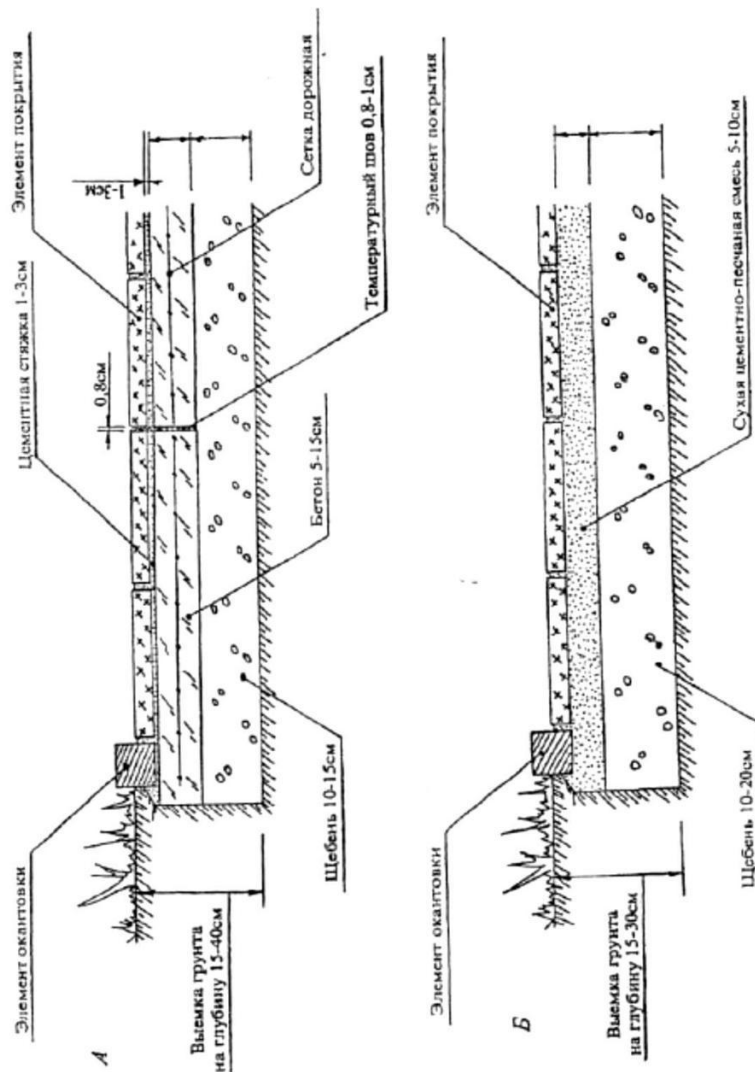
Конструкция садово-парковых дорог из плит (окаймление - садовый бортовой камень, поребрик):
